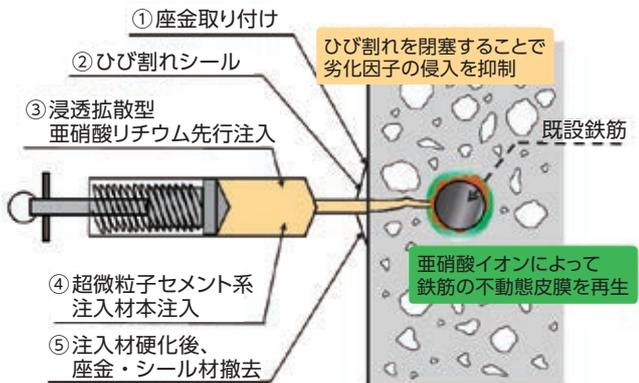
亜硝酸リチウム併用型ひび割れ注入工法の概念図
